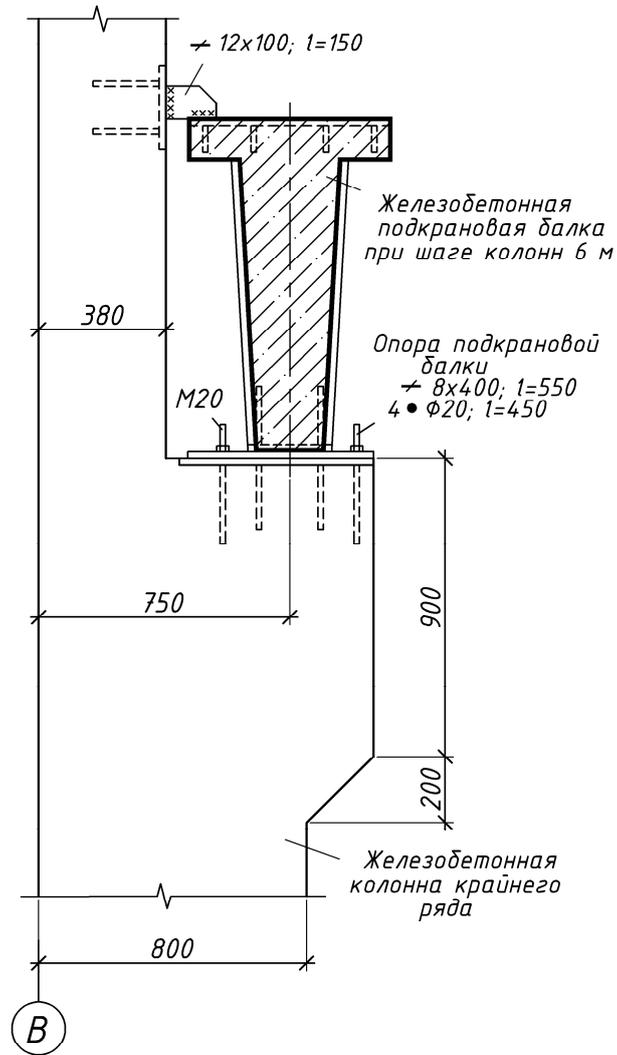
Узел опирания подкрановых балок на колонну крайнего ряда
